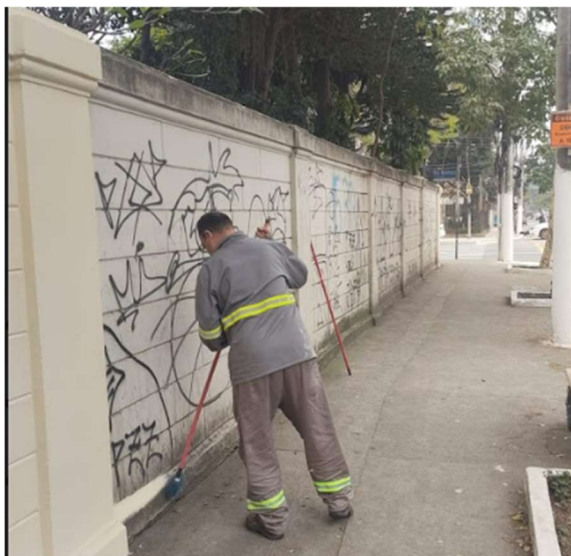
Conservação muros perimetrais, lateral Alameda Gleite.
